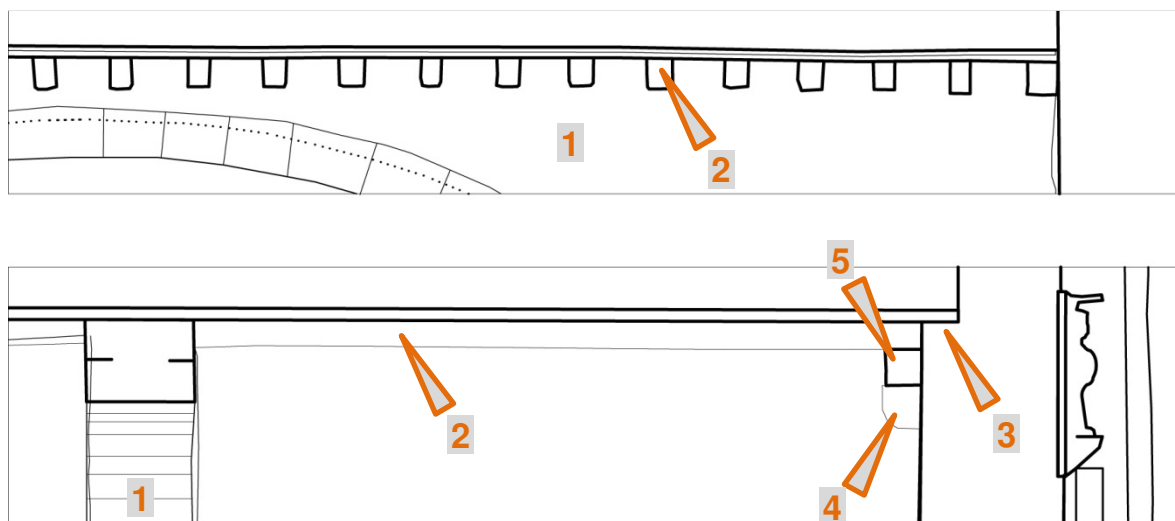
Detail Stockwerk, Dritte Bauphase: Transversaler Schnitt – Bogen (oben); longitudinaler Schnitt - Joch 8
